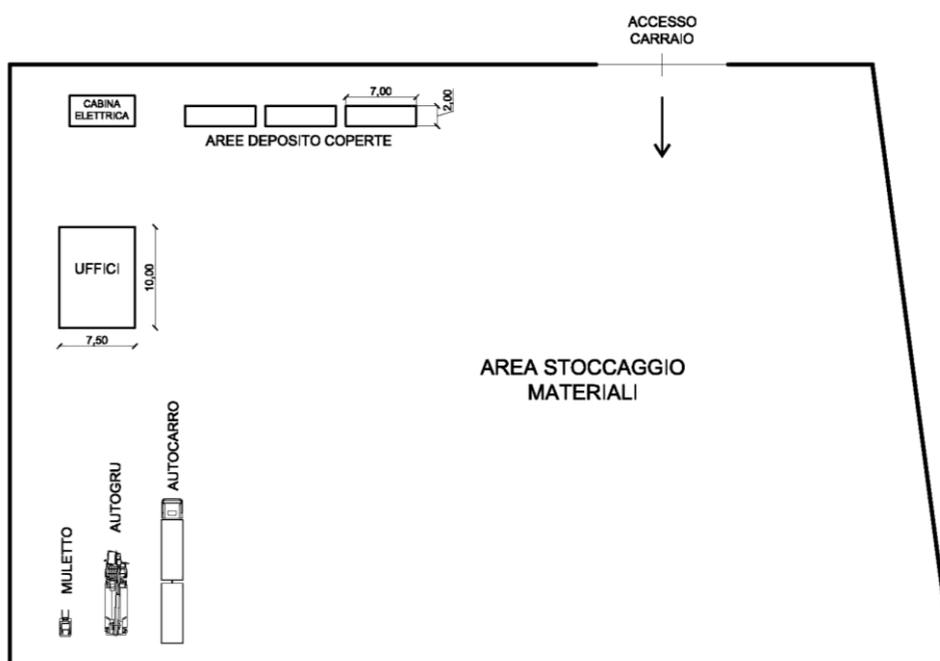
Planimetria dell'Area centrale – Tipologico
